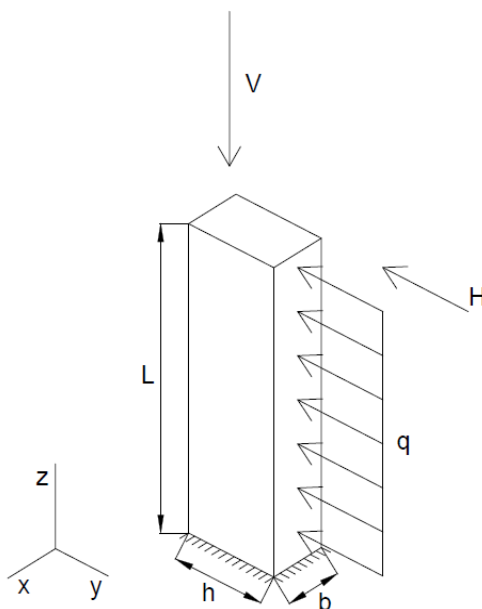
Esquema estrutura dos pilares do telhado curvo.
